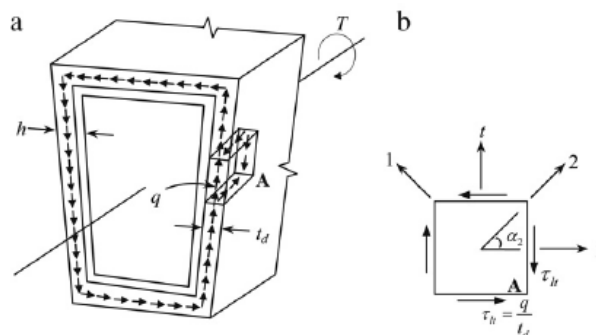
Secção de betão armado sujeita à torção: (a) fluxo de corte da secção; (b) estado de tensão do elemento A [37]
